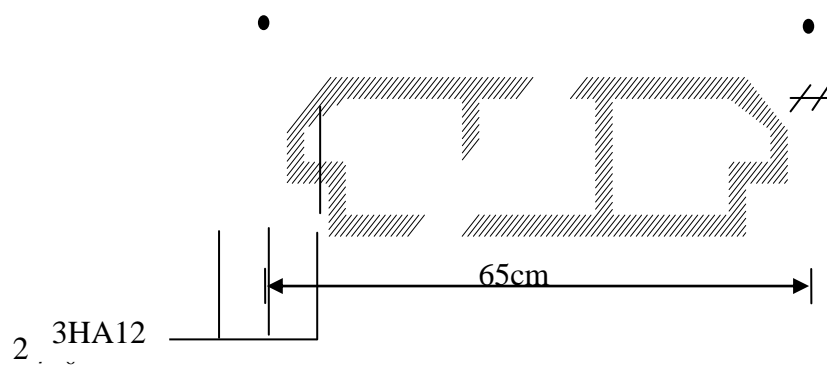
Plan de ferrailage du plancher en corps creux.
